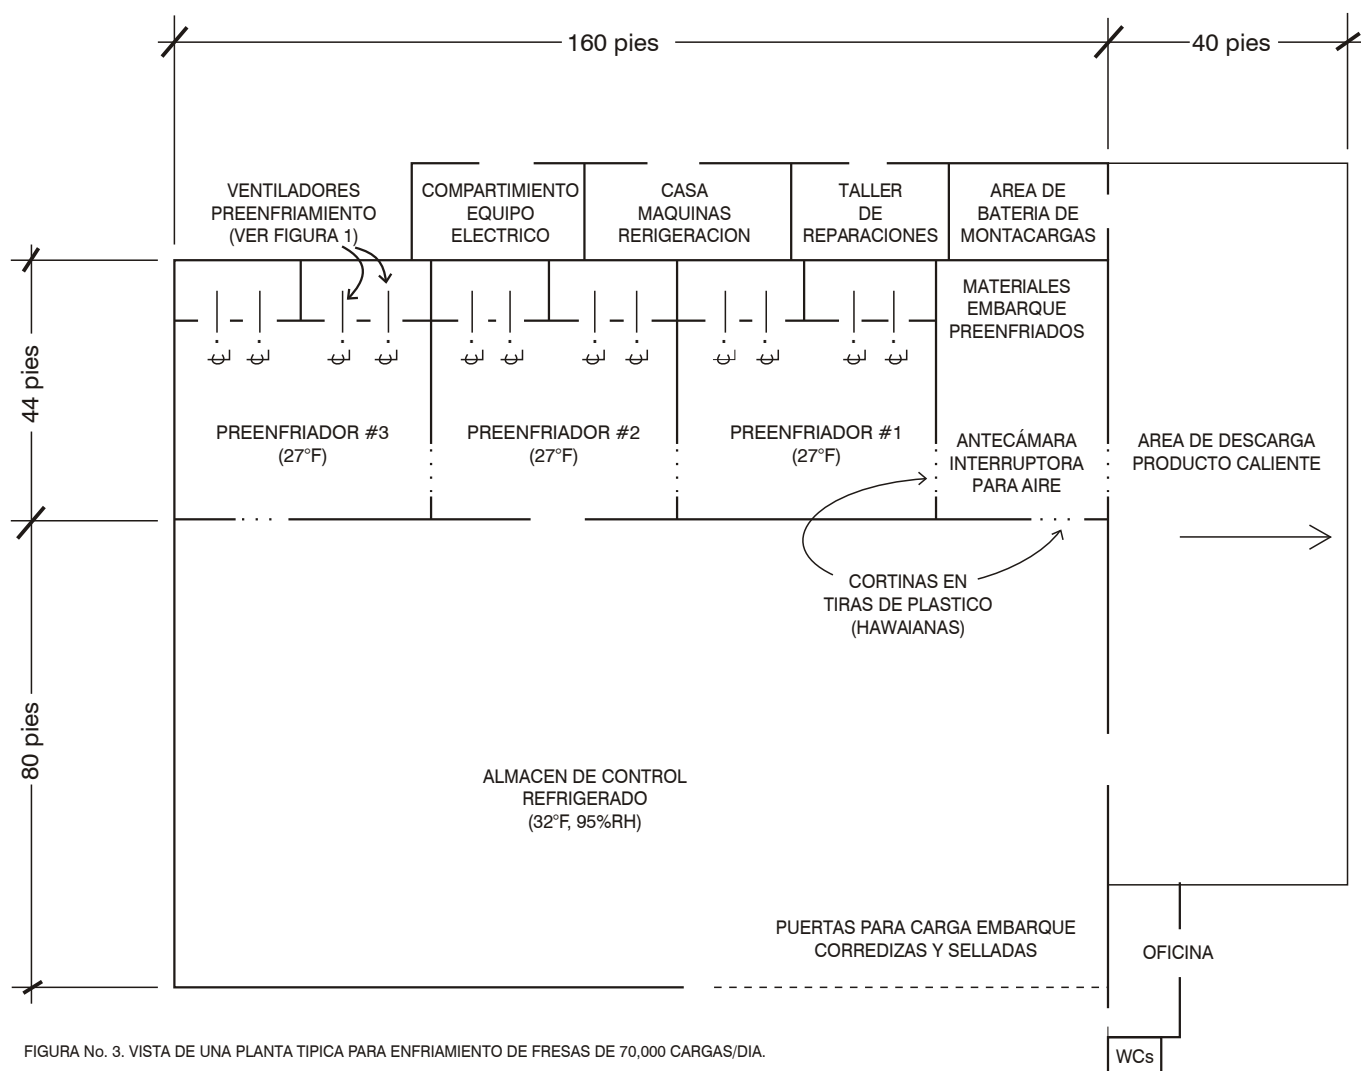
VISTA DE UNA PLANTA TÍPICA PARA ENFRIAMIENTO DE FRESAS DE 70,000 CARGAS/DÍA.
